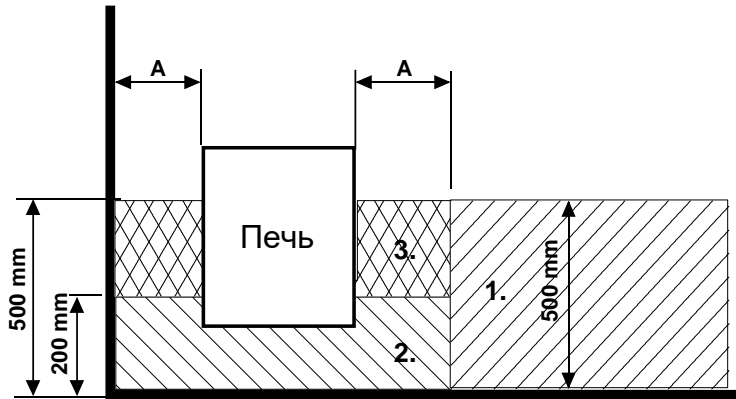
Расположение соединительной коробки для соединительного кабеля в помещении сауны
